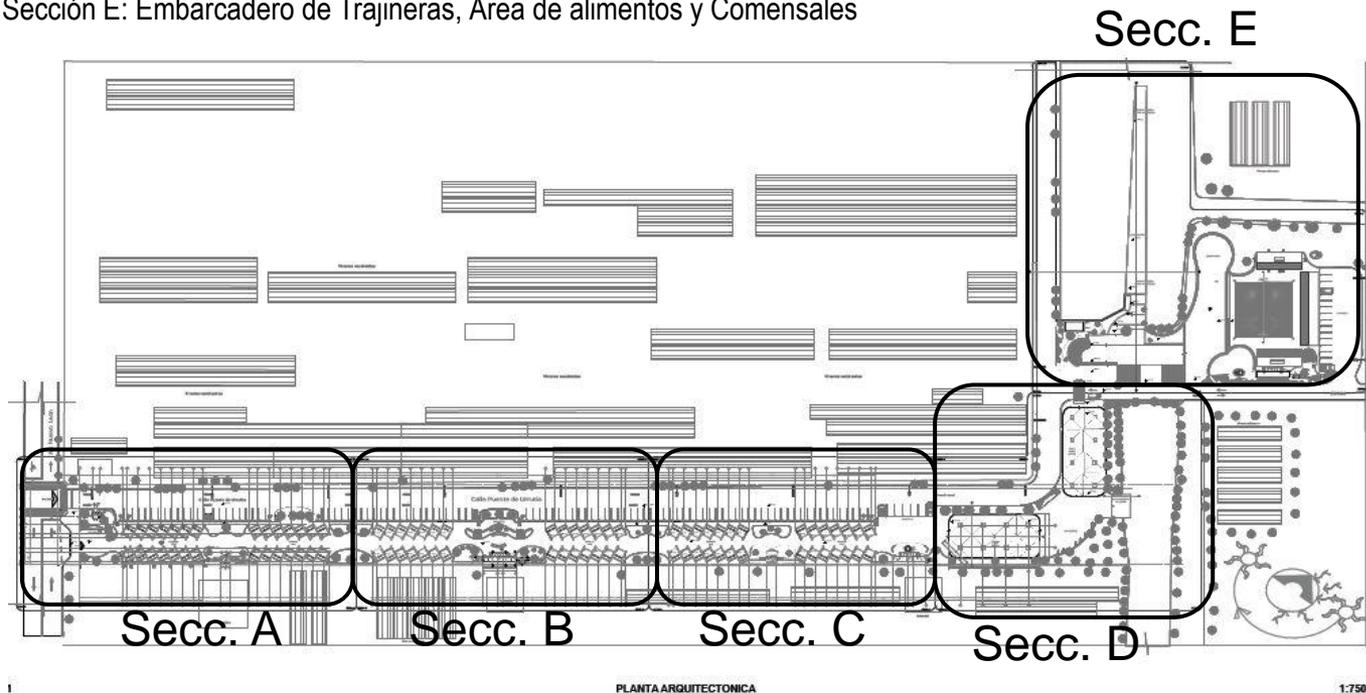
Planta Arquitectónica de Proyecto "Embarcadero Puente de Urrutia", generado en ArchiCAD. Graphisoft
